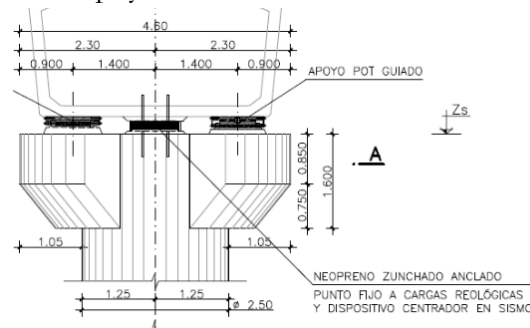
Alzado lateral de estribo como neoprenos de recentrado (Carlos Fernandez Casado)
